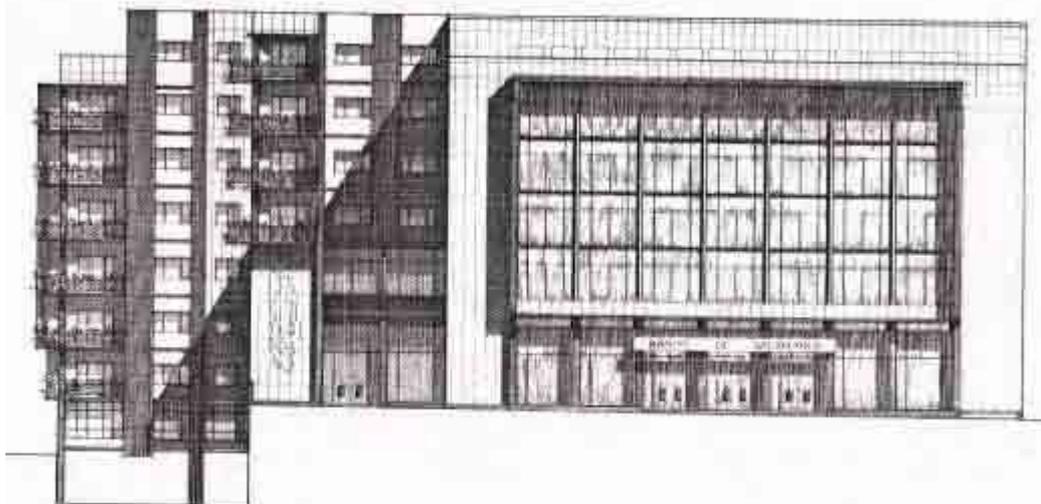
Alzado de la fachada del norte del Banco de Castilla. Fernando Población del Castillo (1963)
